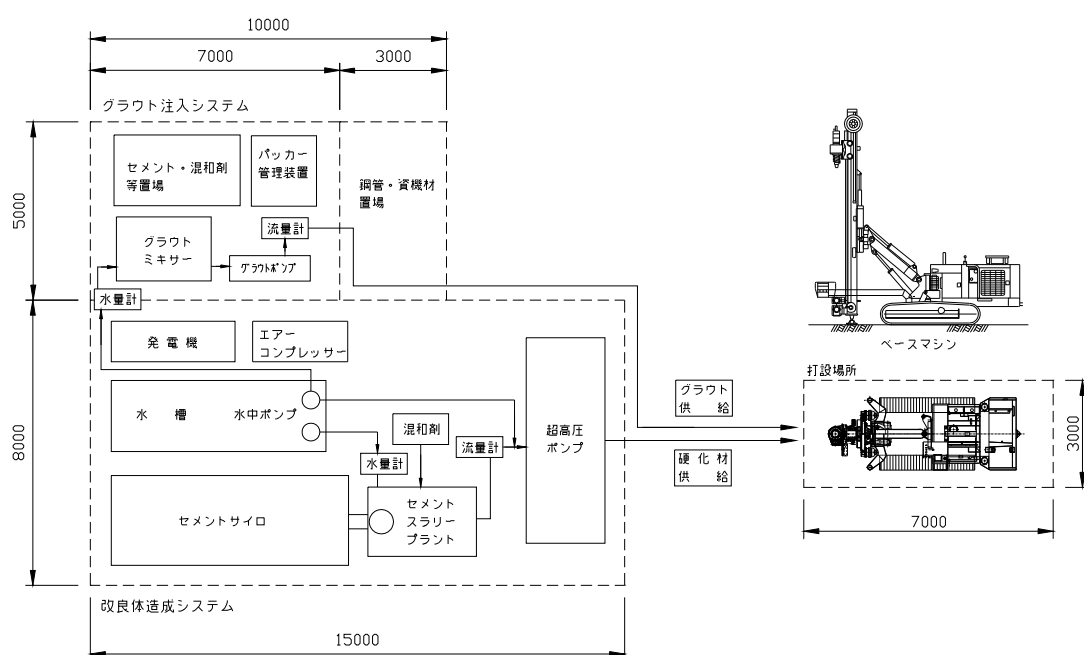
STMP タイプⅡの施工ヤード配置例
